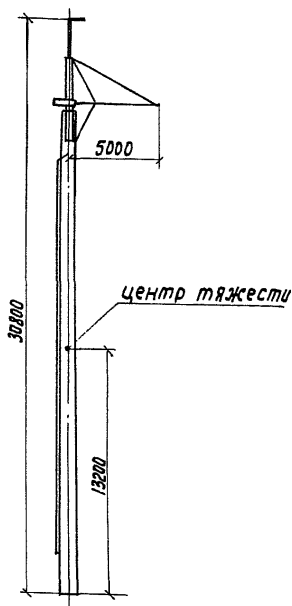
Монтажный элемент раздельной установки стрек
